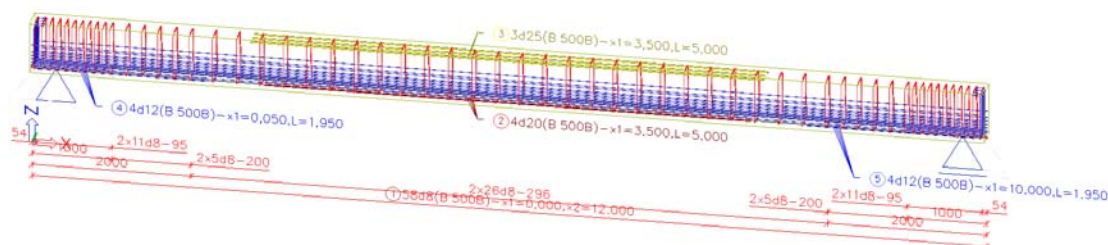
Exemple d'une poutre préfabriquée en béton précontraint dans Scia Engineer, avec étriers prédéfinis et ferrailage détaillé
